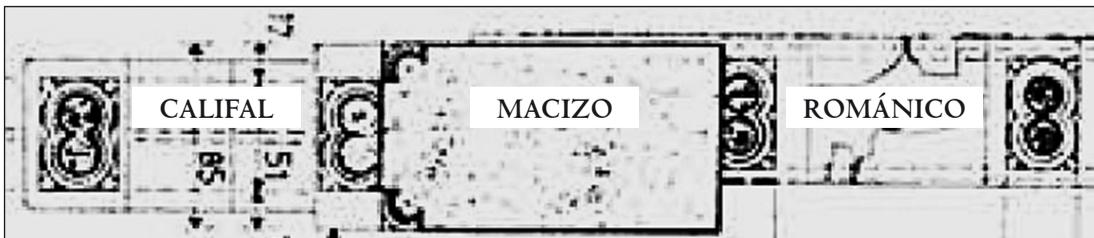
Detalle en planta del descentramiento entre el macizo y la zona románica.
